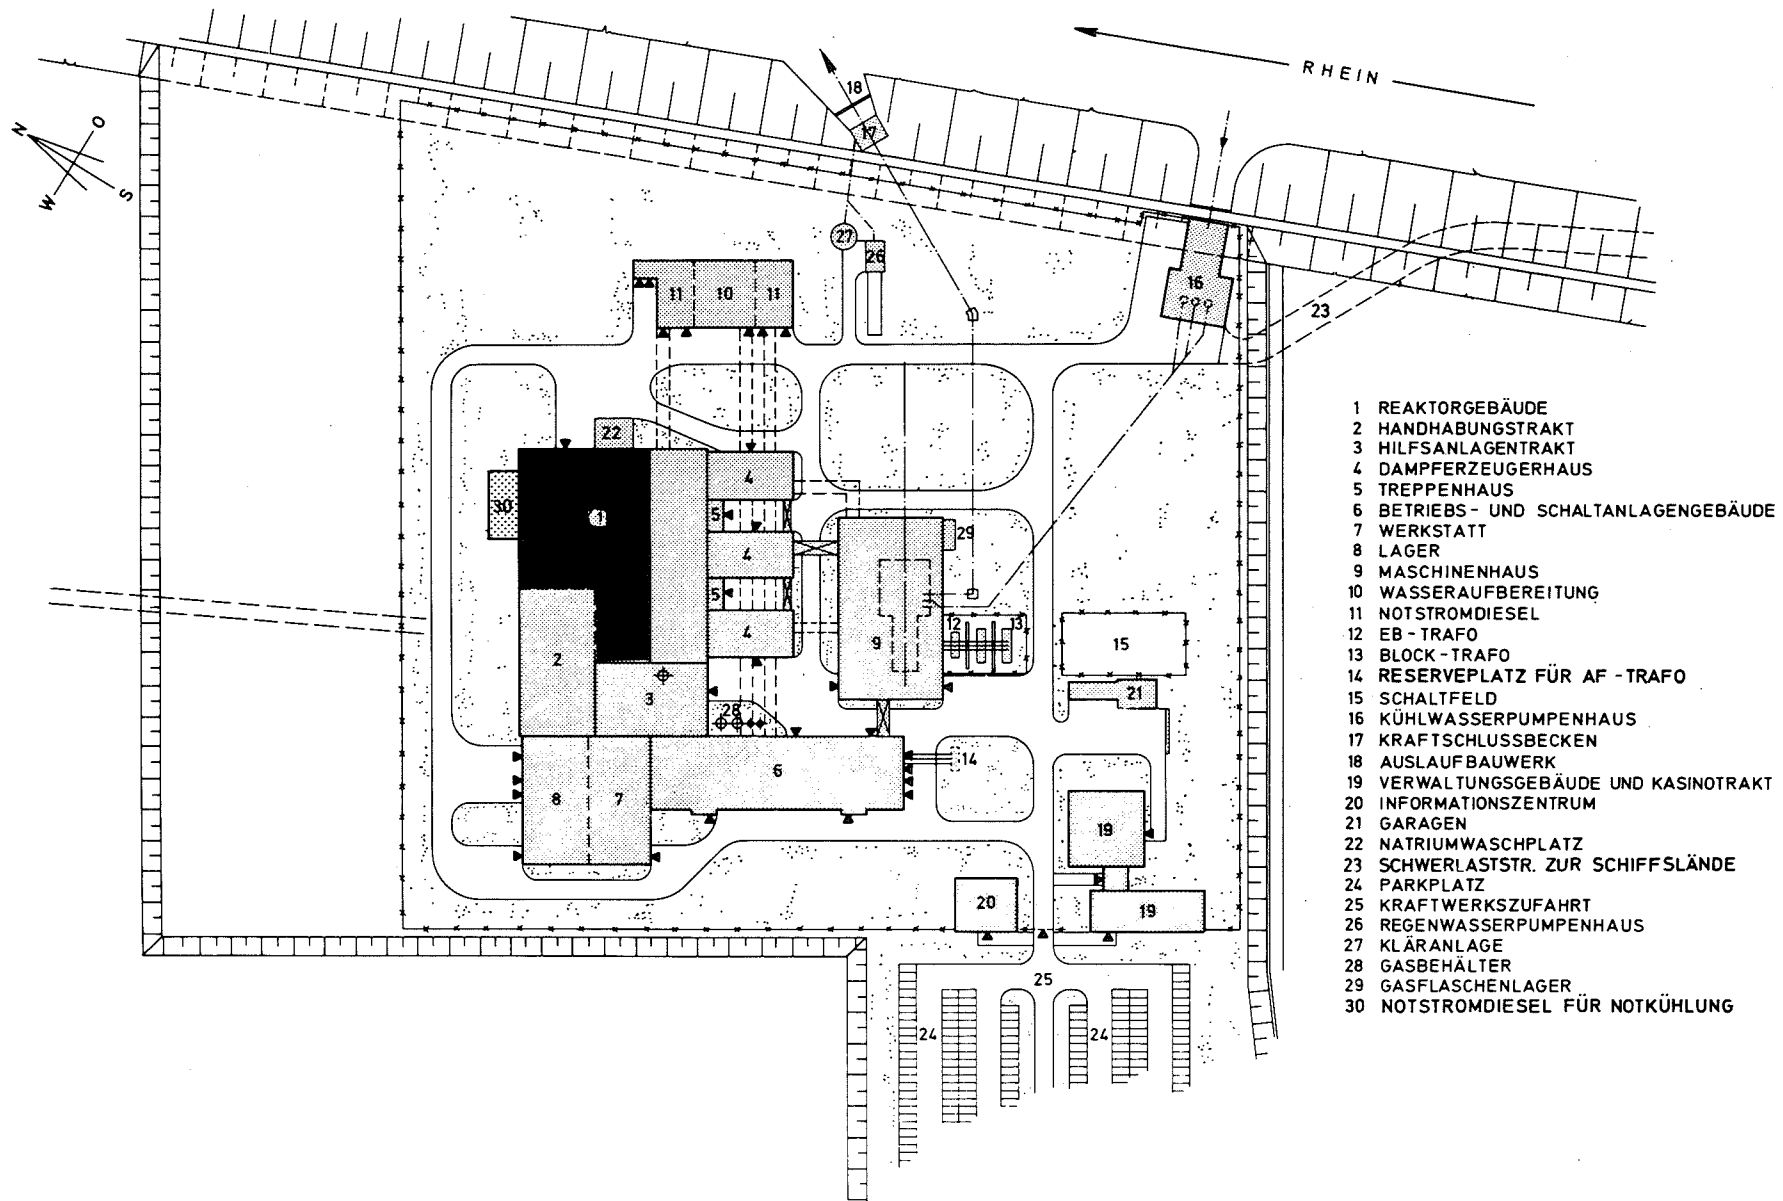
Kernkraftwerk SNR-300, Lageplan
